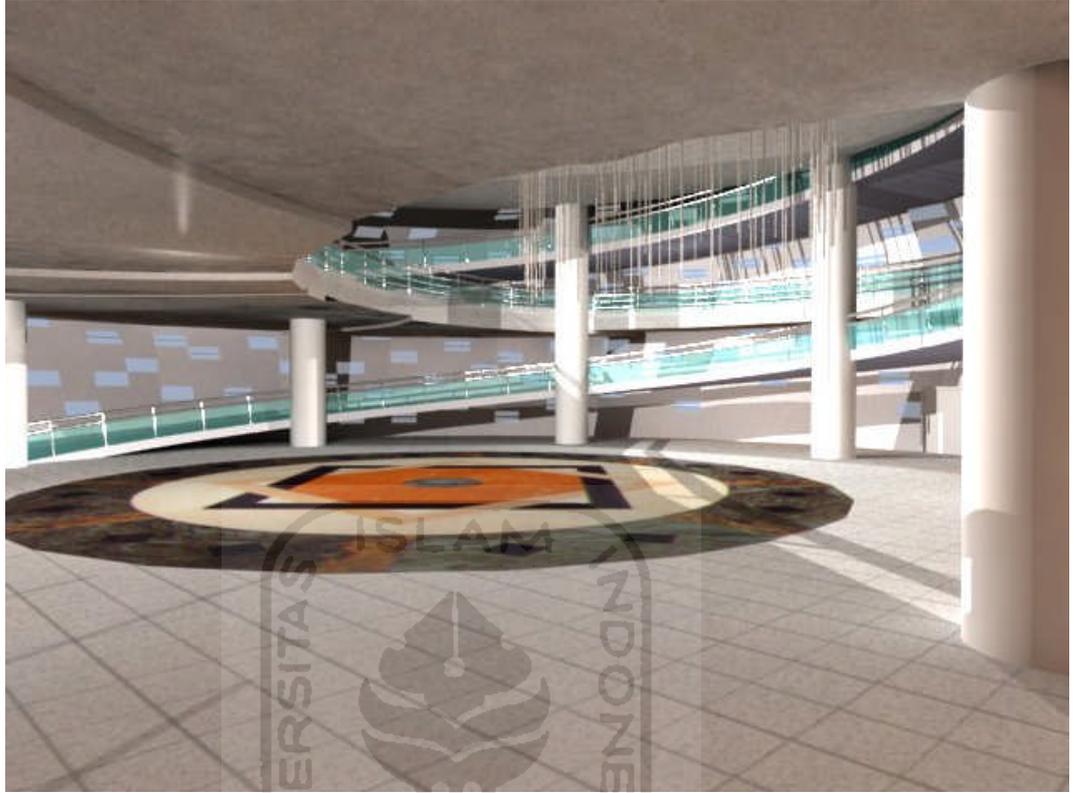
View dari beranda ruang baca perpustakaan senja hari
